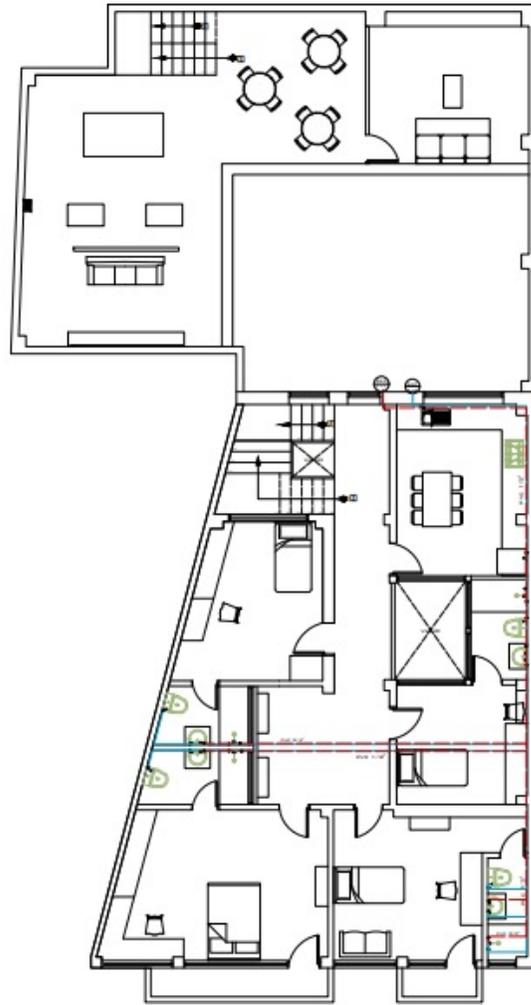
Instalaciones Hidrosanitarias Planta Baja
